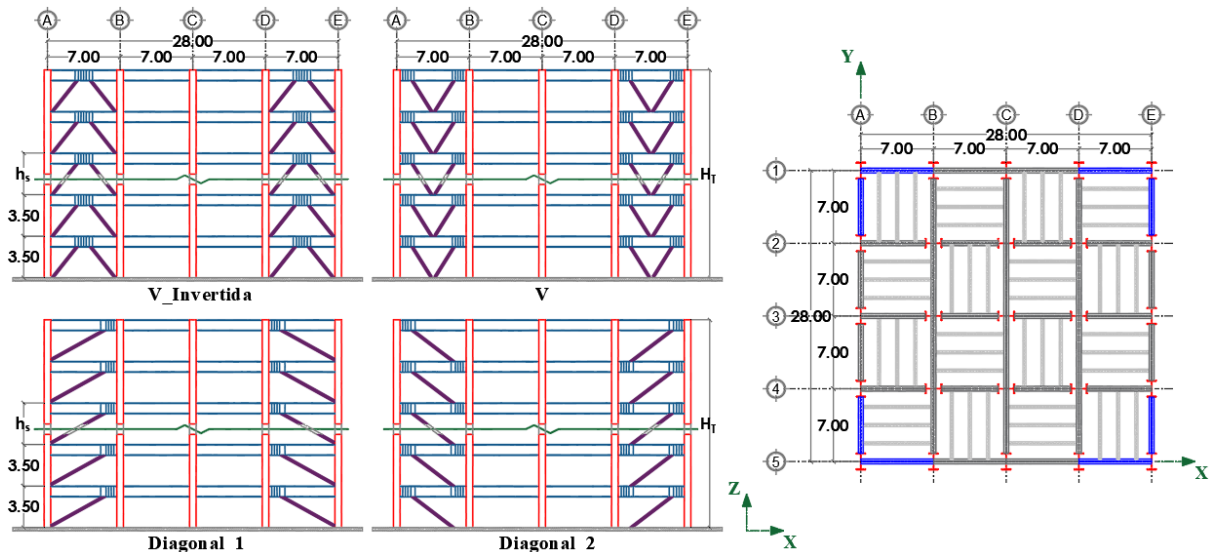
Elevación, vista en planta y ubicación de elementos (unidades en metros)
